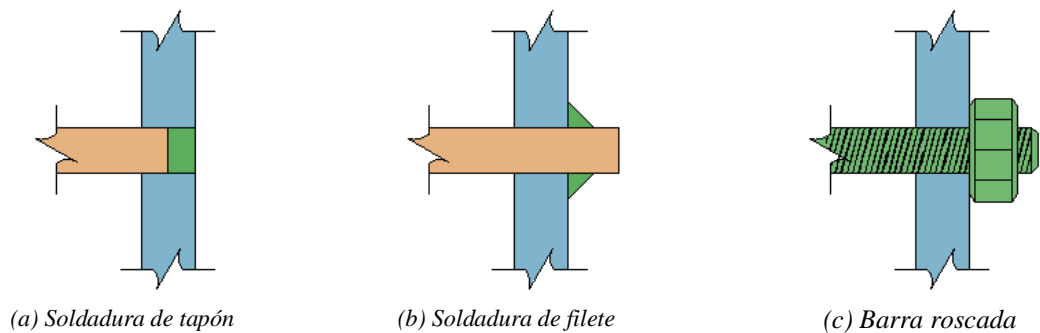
Detalle de conexiones de barras de unión con placas de acero
